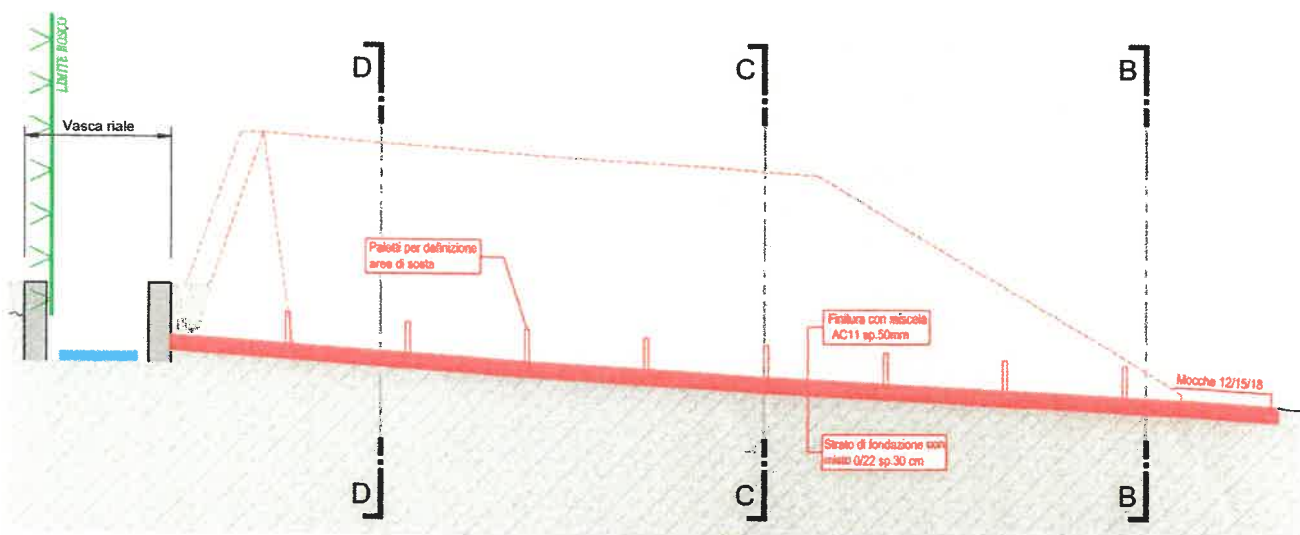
Sezione A-A - area di sosta e muro di contenimento
